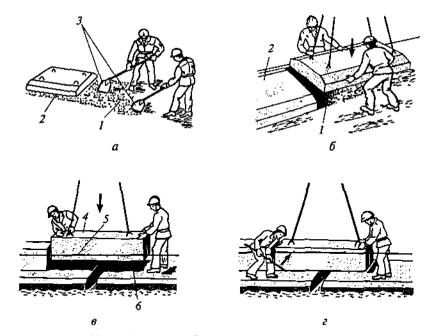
Установка сборных элементов фундаментов: a — подготовка песчаного основания;  $\delta$  — установка железобетонной подушки фундамента;  $\delta$  — установка стеновых блоков;  $\epsilon$  — выверка в плане стенового блока;  $\delta$  — песчаное основание;  $\delta$  — установленный элемент;  $\delta$  — лопата;  $\delta$  — стеновой блок;  $\delta$  — осевая проволока;  $\delta$  — растворная постель
